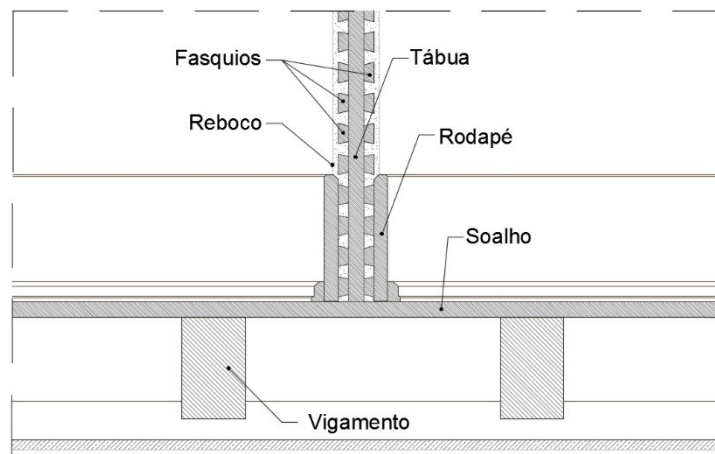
Pormenor de parede divisória em tabique (s/escala) – (Autor)
